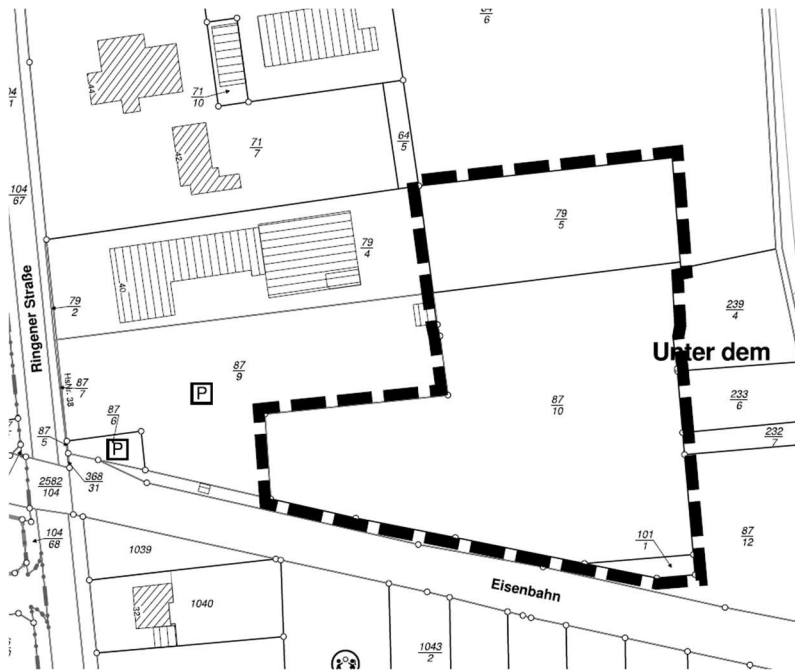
Lageplan mit Abgrenzung der pot. Erweiterungsflächen
